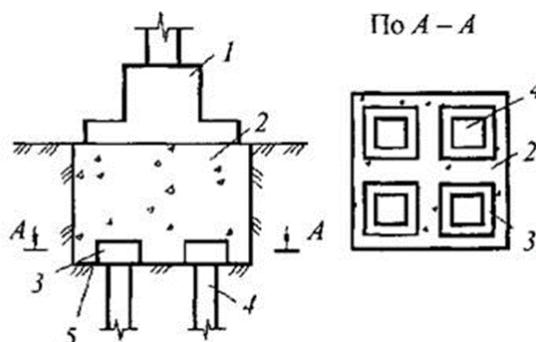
Свайный фундамент с промежуточной подушкой: 1 - фундаментный блок; 2 - промежуточная подушка; 3 - железобетонный оголовок; 4 - железобетонная свая; 5 - дно котлована
